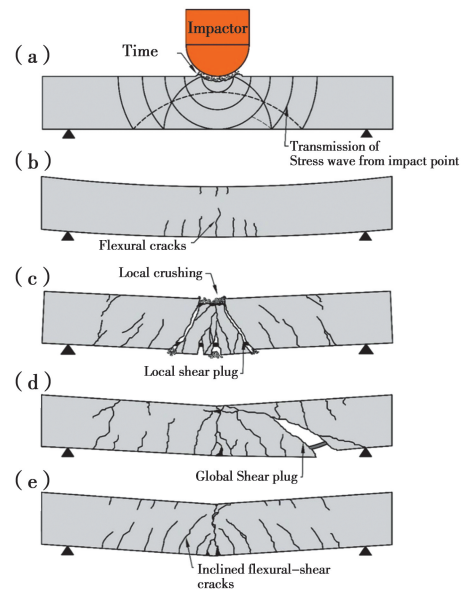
受冲击荷载作用下钢筋混凝土梁的理论响应
